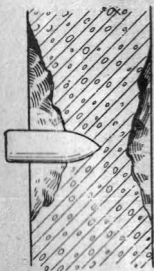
Входная отколыная воронка в бетонной стенке с отколом на обратной стороне
